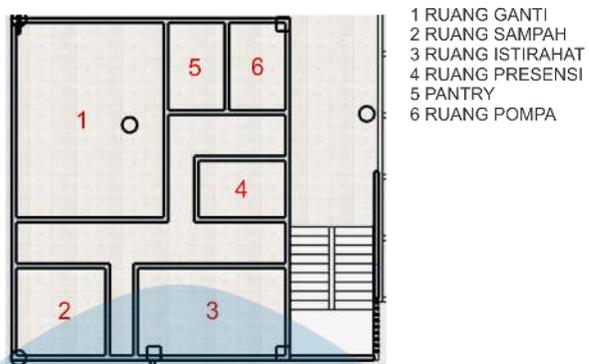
Zonasi Ruang Pengelola Lantai 2
